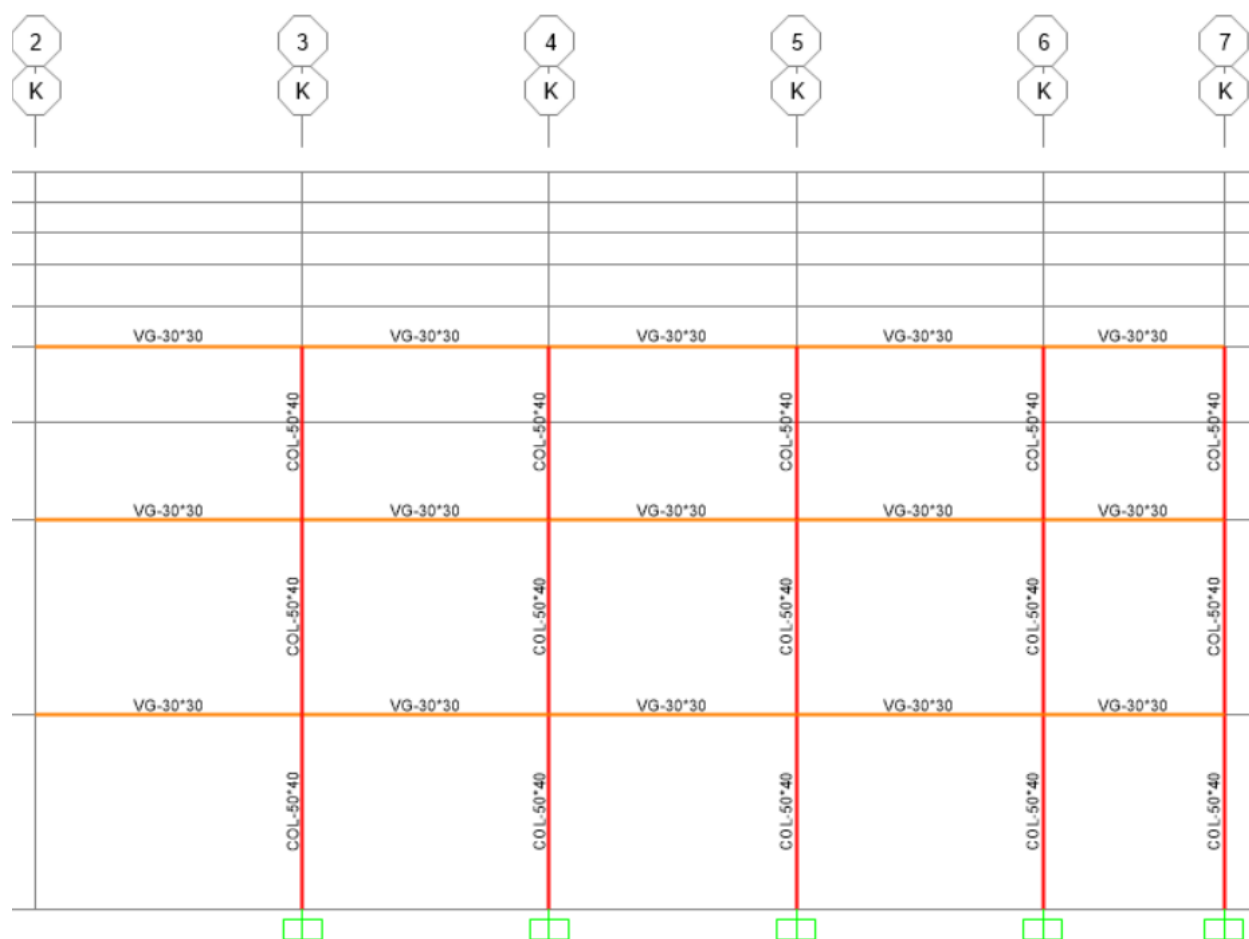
Vigas de 30x30 y columnas de 50x40
